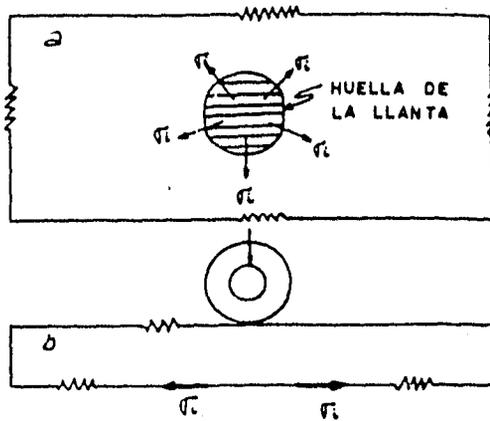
Esfuerzos de tensión que se presentan en un pavimento rígido, en el caso que la huella esté hacia el centro de la losa (esfuerzos interiores), (a) planta, (b) sección.
